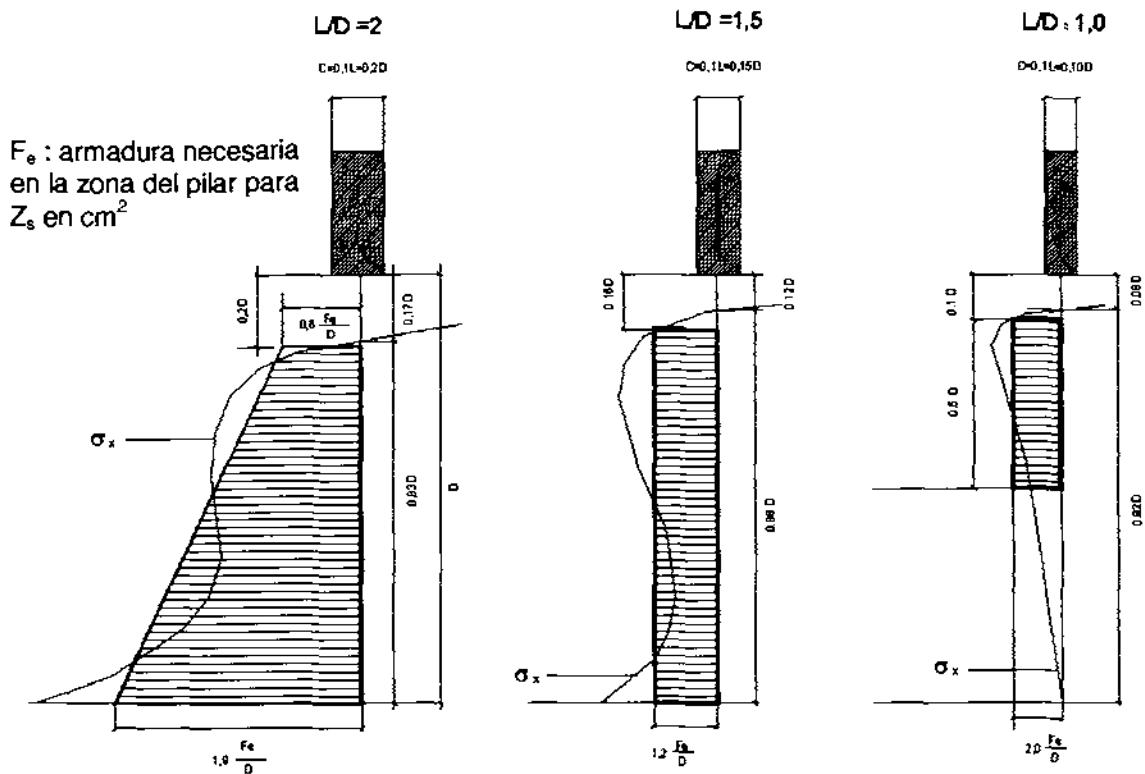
Indicaciones para la distribución de la armadura principal de tracción en la zona de pilares de fachada en muros de sótano.
